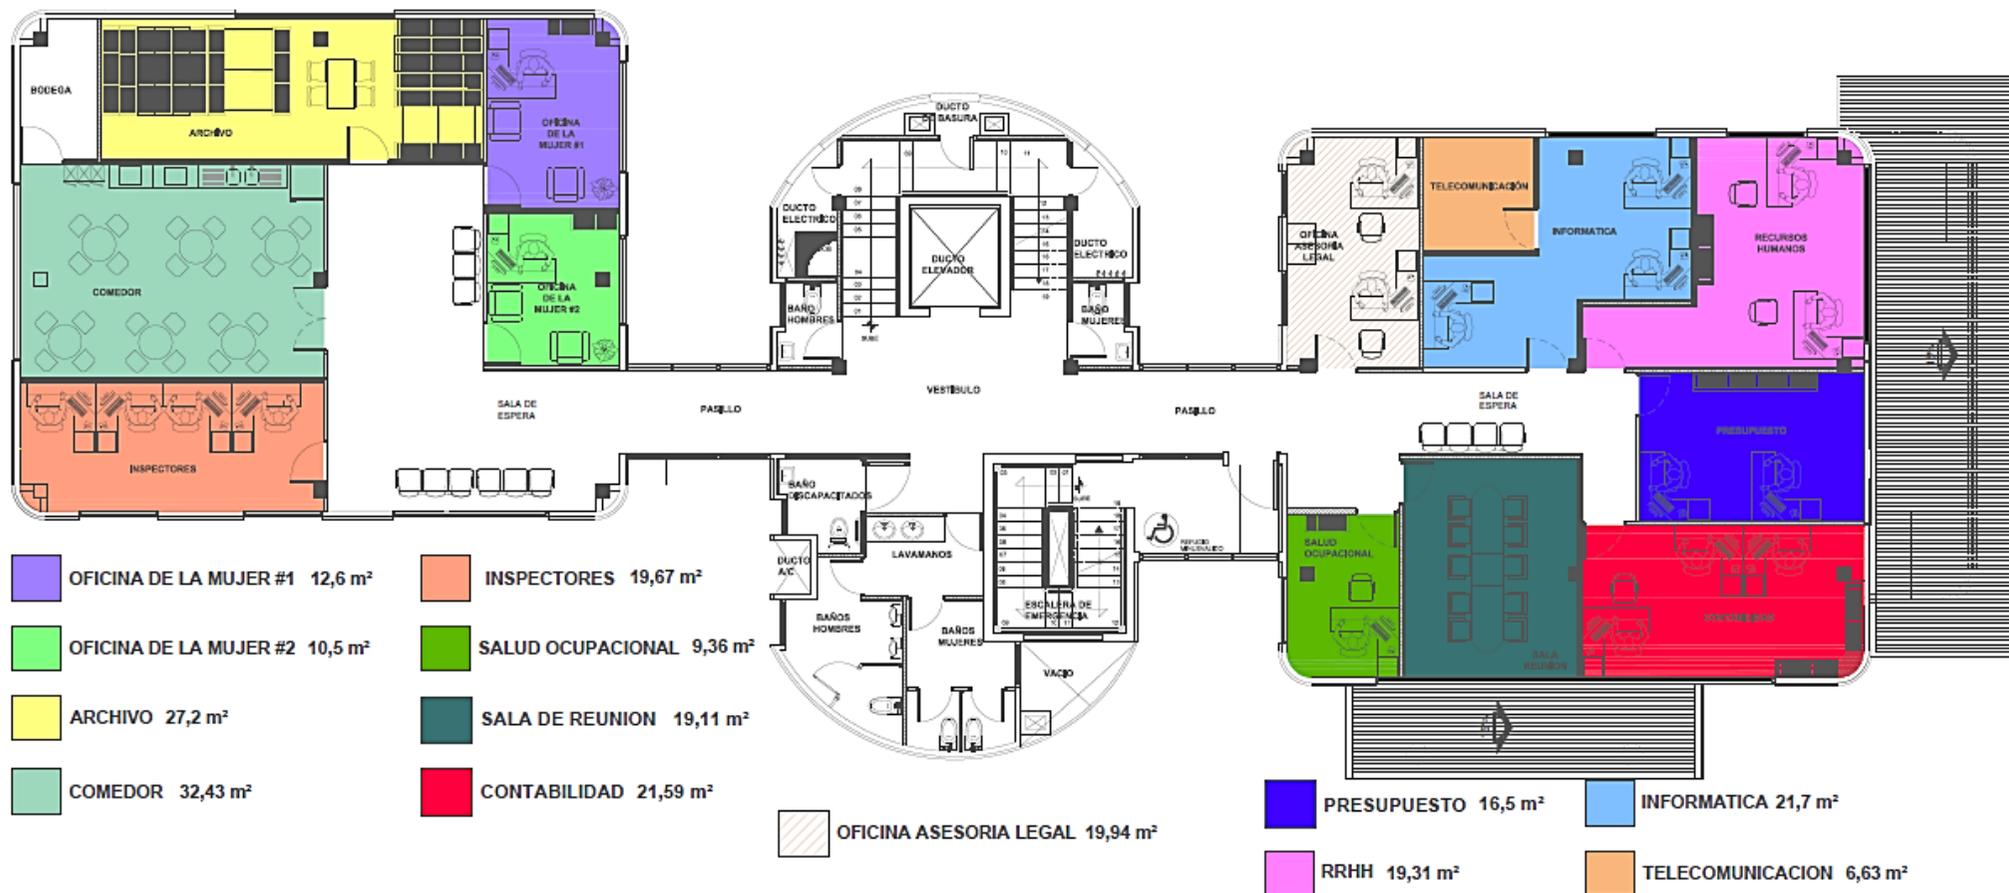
Distribución de oficinas en planta arquitectónica, nivel 02
